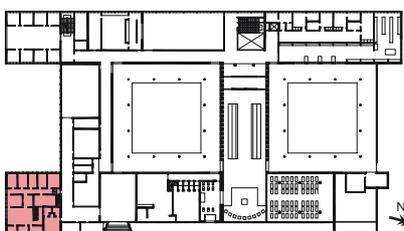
Localização da atual hospedaria para leigas no primeiro pavimento. (Desenho da autora).
